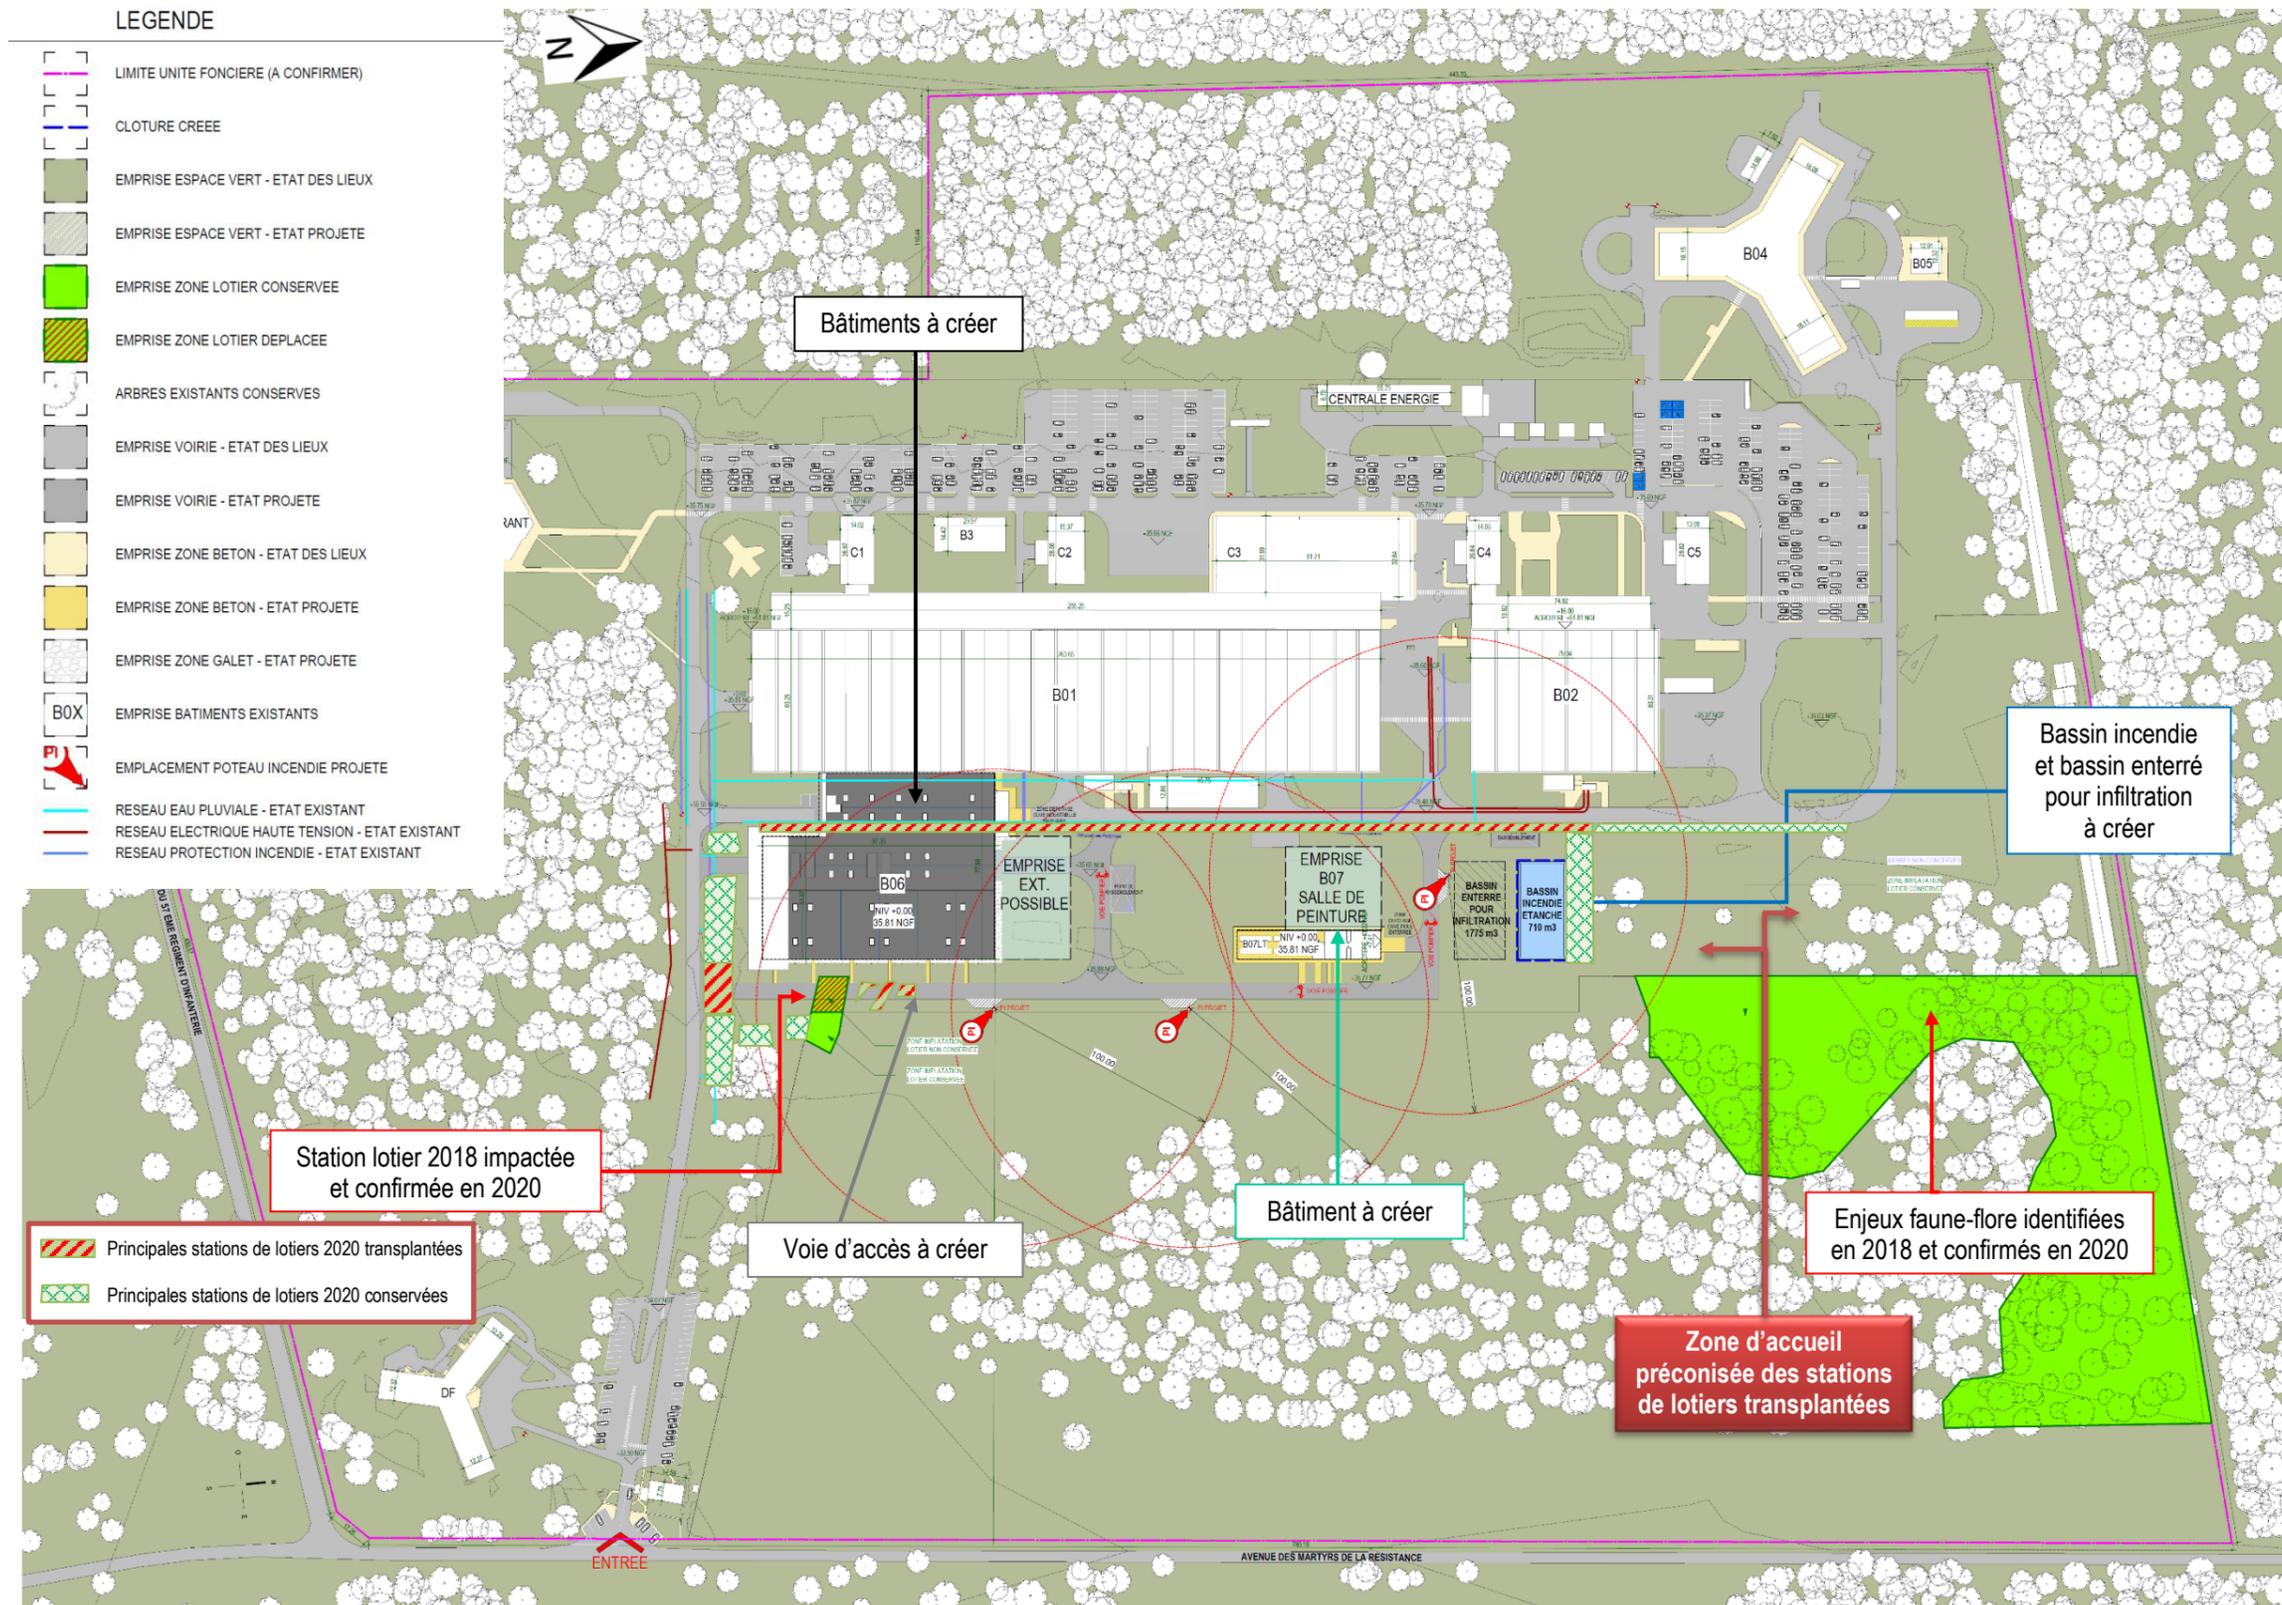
Plan de masse du projet (plan de Dassault Aviation).
